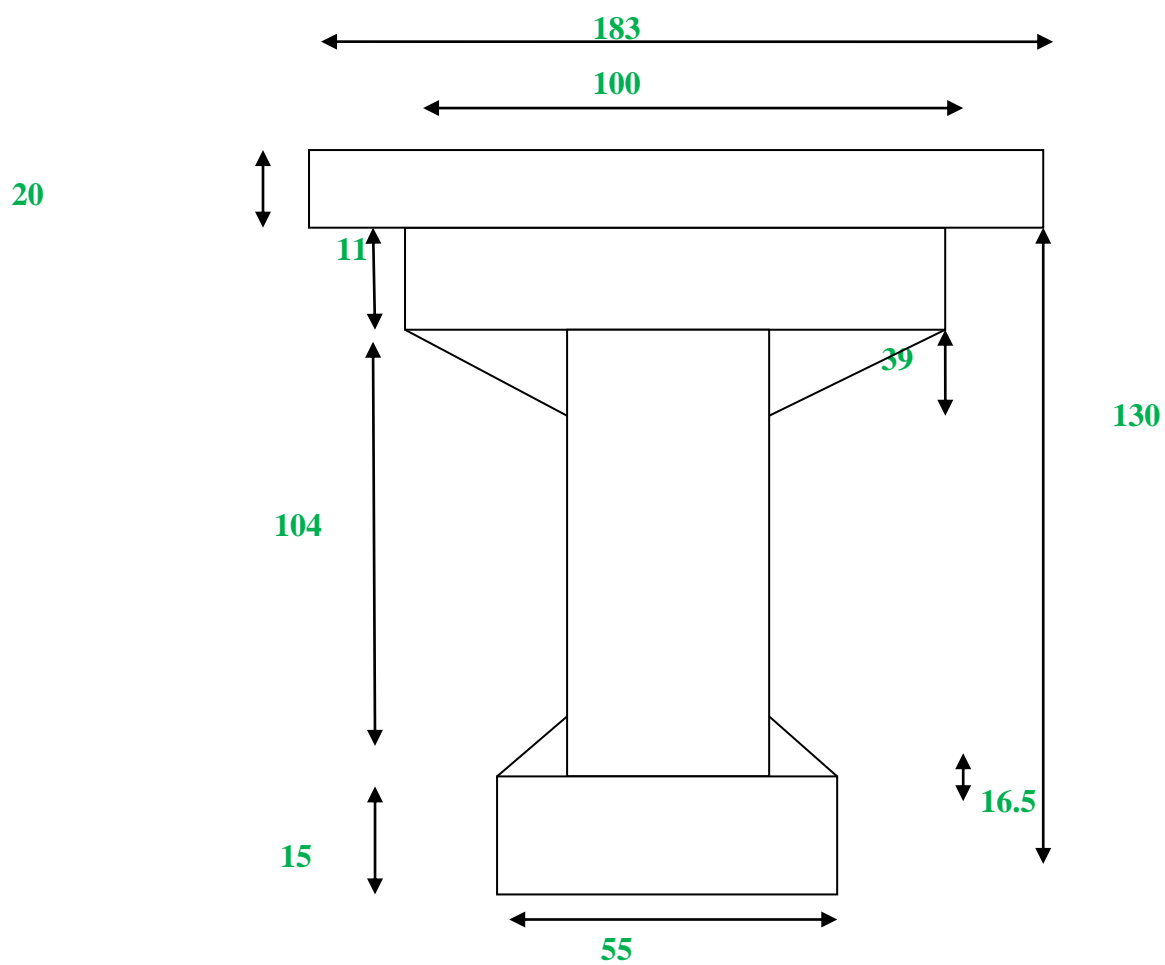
Dimensions de la poutre 'intermédiaire A mi travée avec hourdis.
